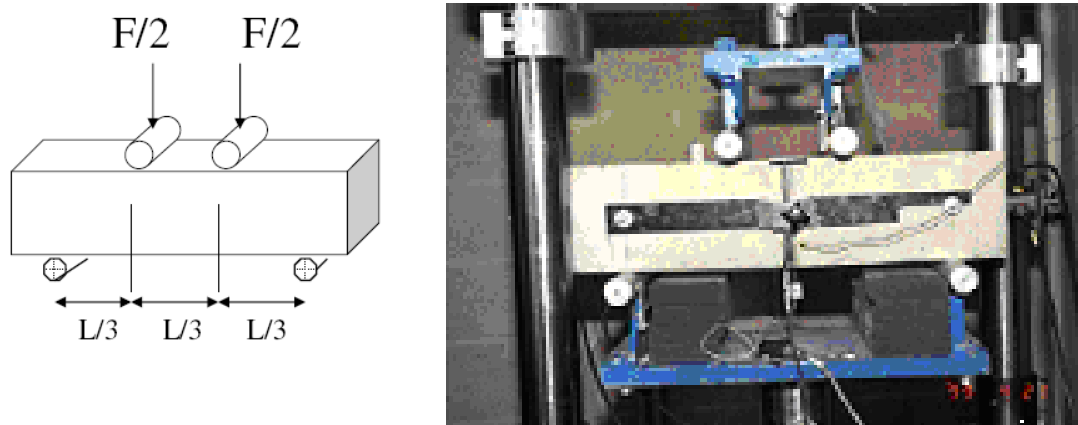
Pontos de carregamento em vigas EFNARC [10]
